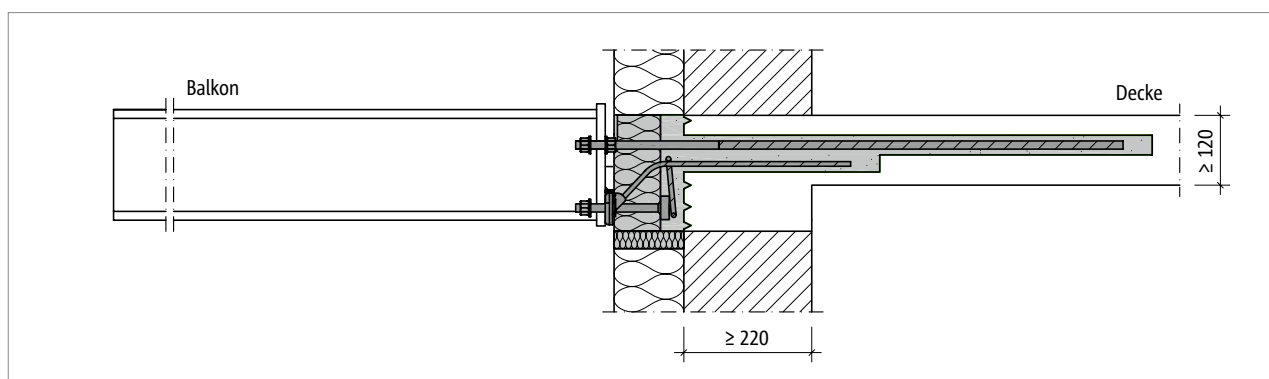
Schöck Isokorb® RT Typ SK: Anschluss bei Wärmedämmverbundsystem (WDVS) und dünner Decke
